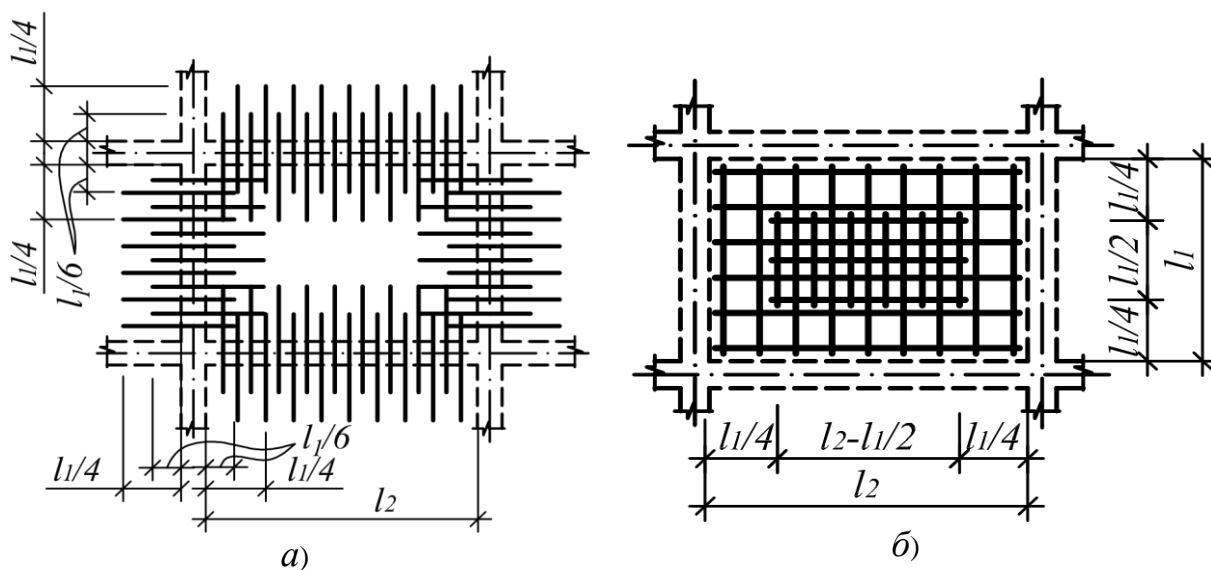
Схеми армування окремими стержнями плит, опертих по контуру:
